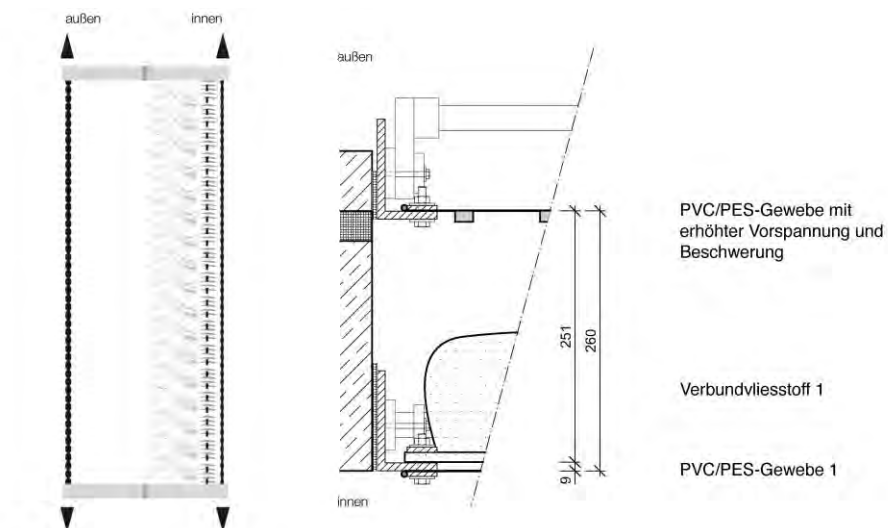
Systemskizzen und Schnitt des Prüfaufbaus A3 – wie A2; mit beschwertem Deckgewebe
